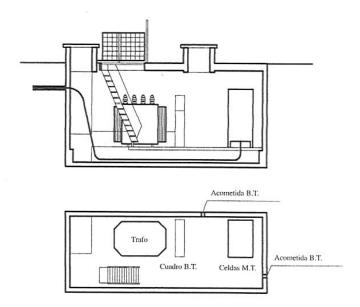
Planta y alzado de un centro de transformación subterráneo [13].
